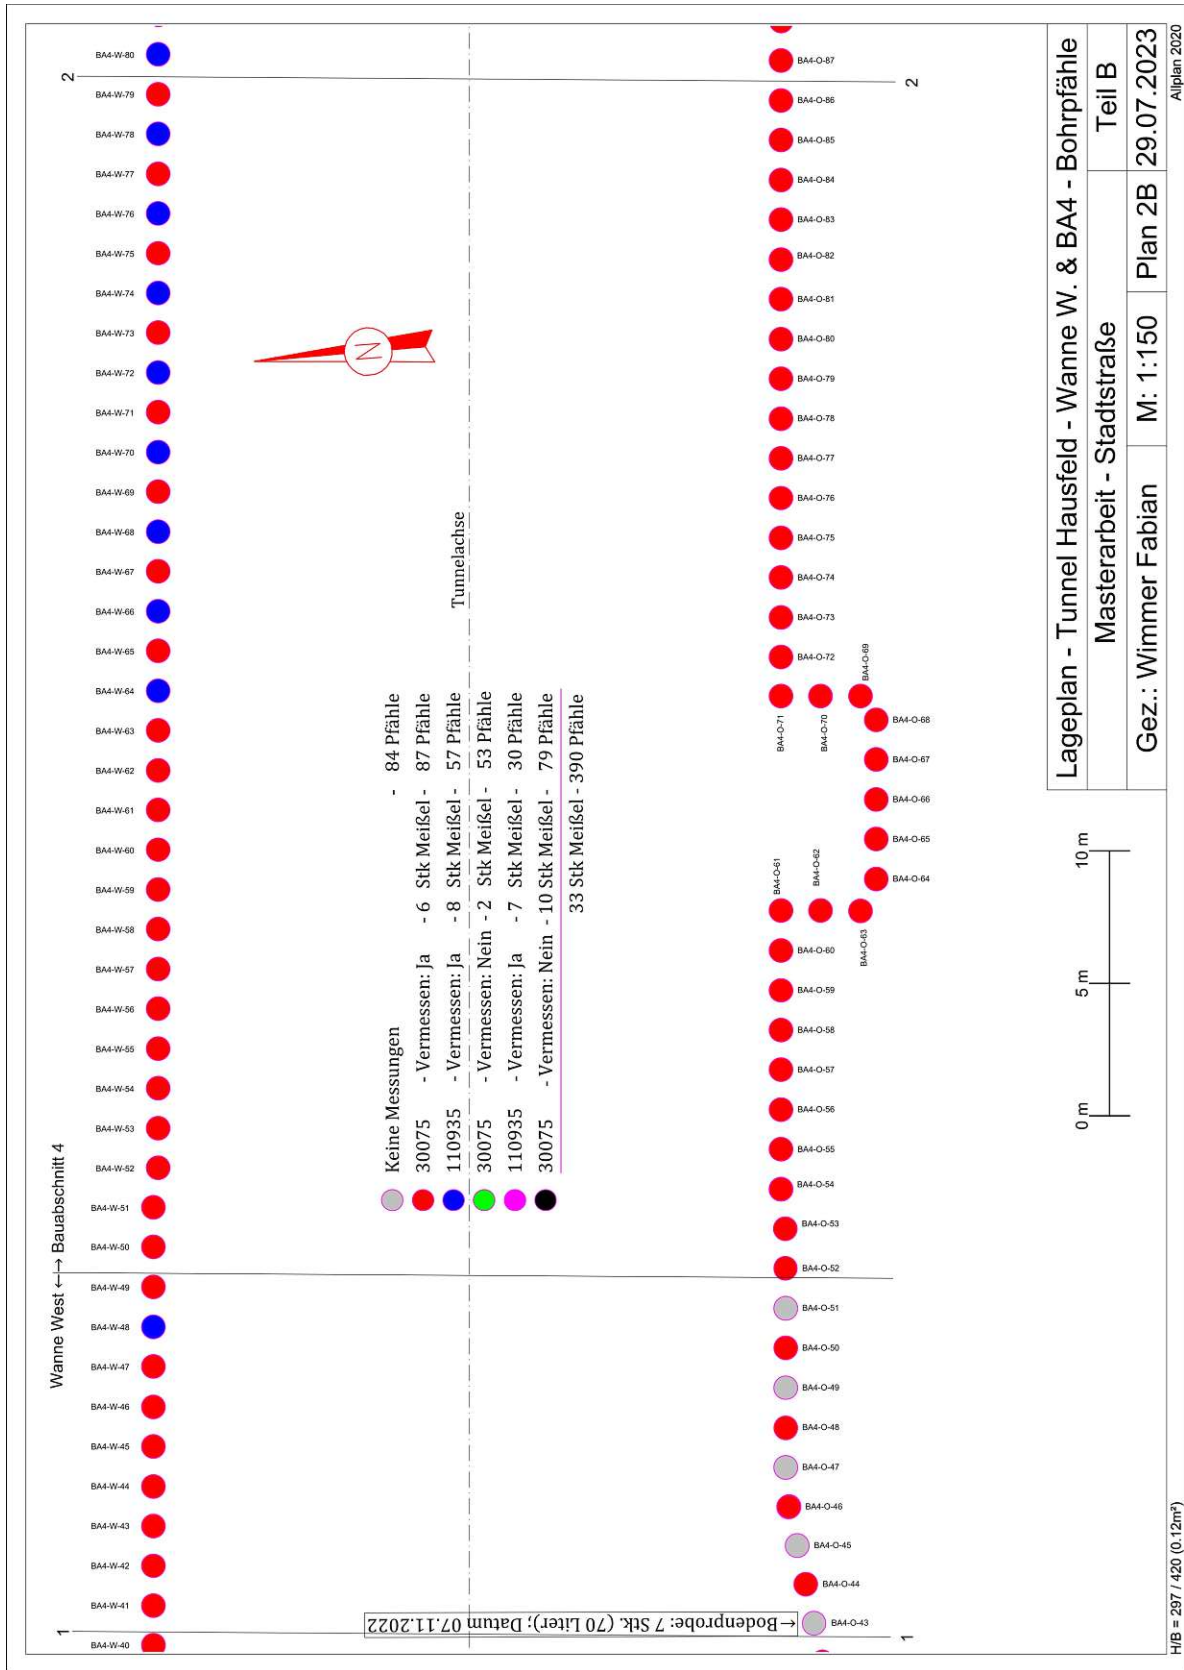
Lageplan - Tunnel Hausfeld, Wanne West und BA4 - Detailansicht Plan 2B; Plangrundlage [15]
